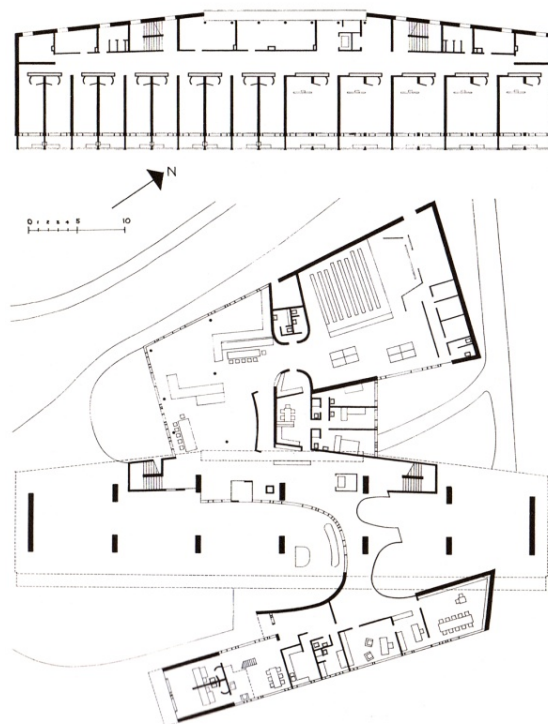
e 25- Planta piso 1 e piso térreo, Casa do Brasil
